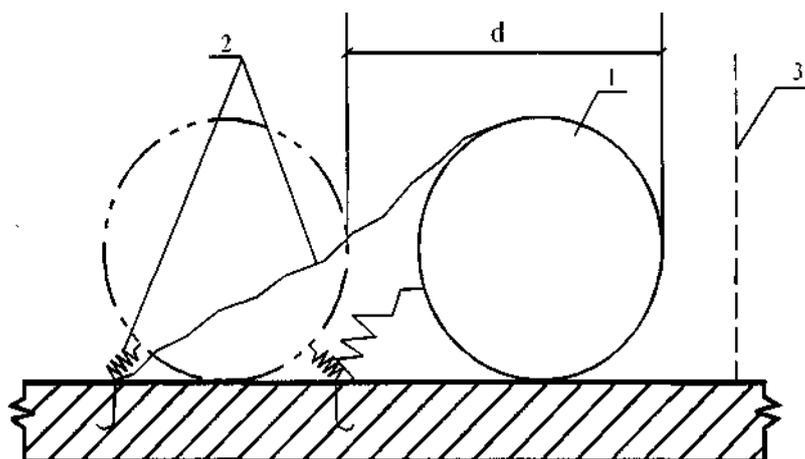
Противоударное упругопластическое устройство, допускающее сдвиг оборудования на безопасное расстояние  $d$ : 1 - оборудование; 2-упругопластический элемент; 3 - граница безопасного (без соударения) сдвига
